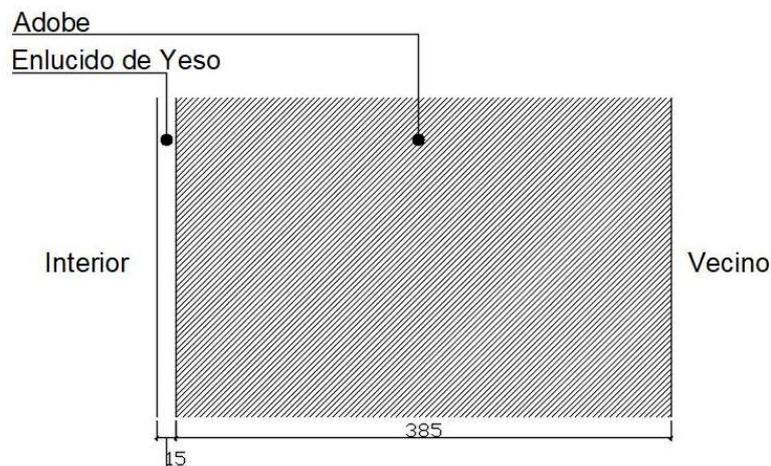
Sección del Muro colindante tradicional cruceño.
